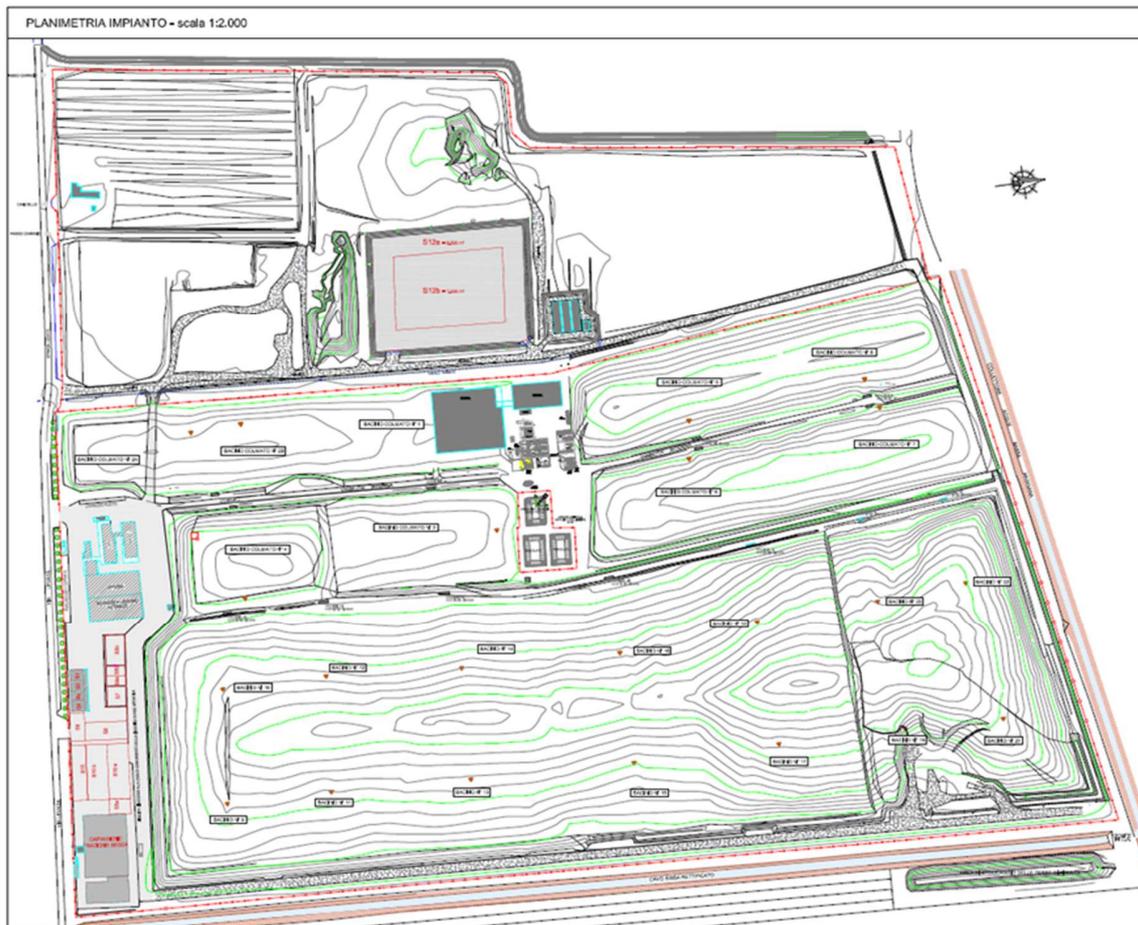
Planimetria del sito impiantistico di S.A.B.A.R.
